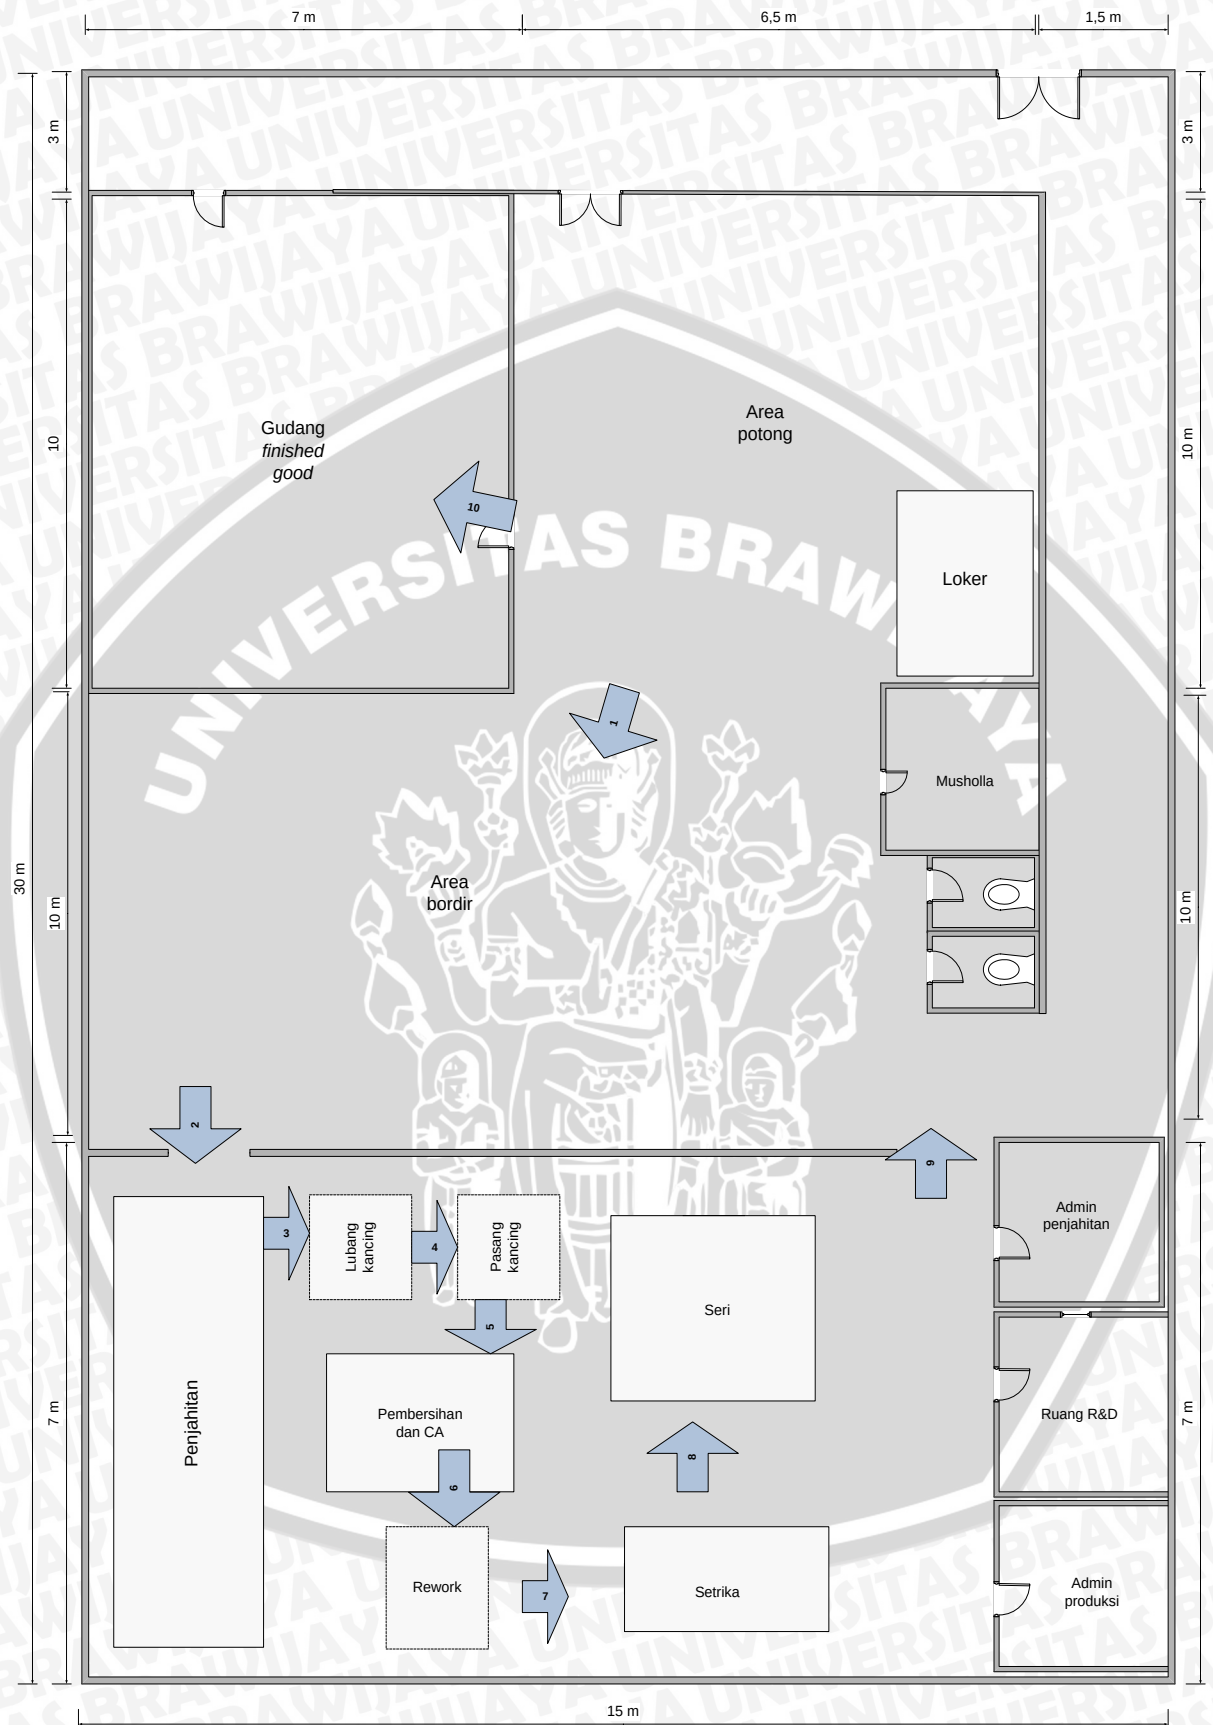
Perbaikan *layout* lantai 1 (alternatif 1)
